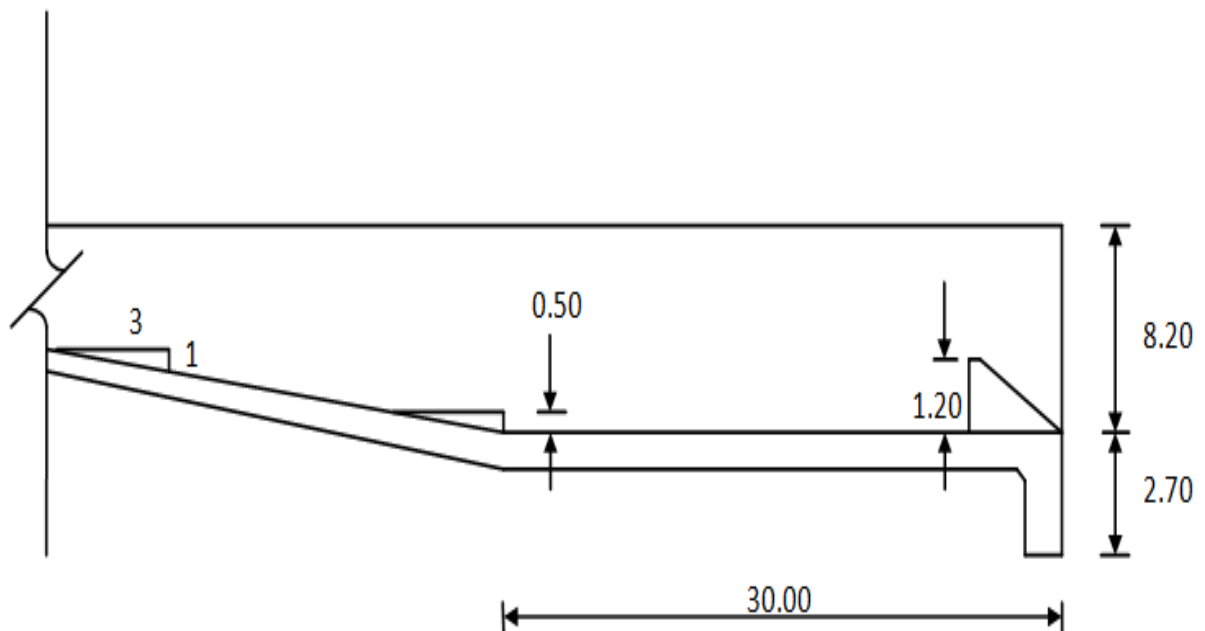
รูป Plan แสดงขนาดอ่างสลายพลังงาน Type II ตามที่โครงการวิศวกรรมออกแบบได้
